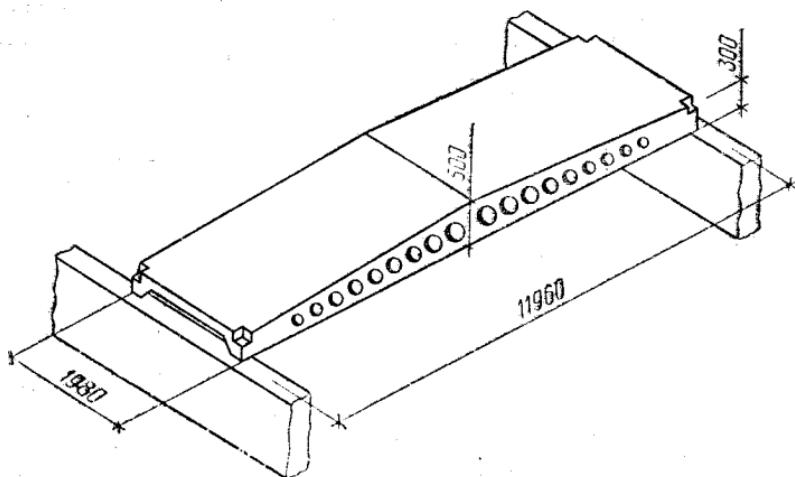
Облегченные плиты покрытия размером  $2 \times 12$  м
